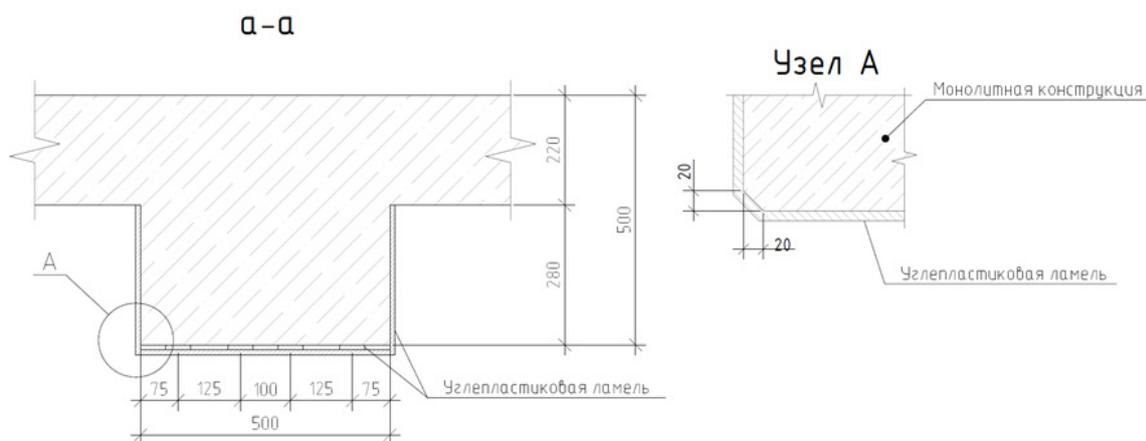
Разрез монолитной железобетонной балки с установленными ламелями
